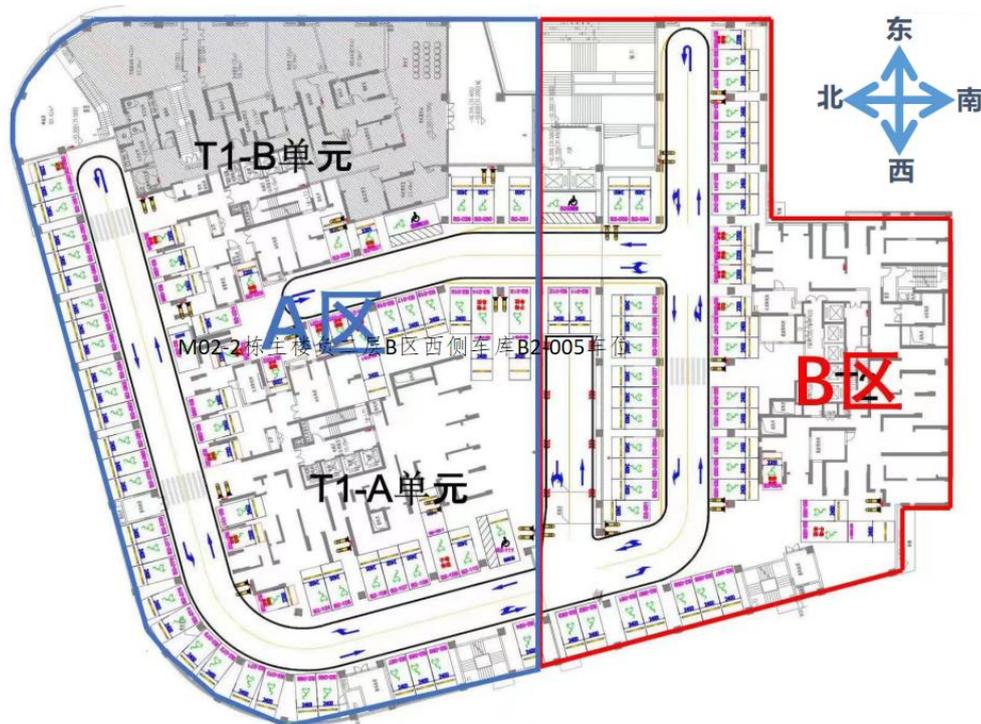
M02-2 栋主楼负二层 A 区、B 区平面图
